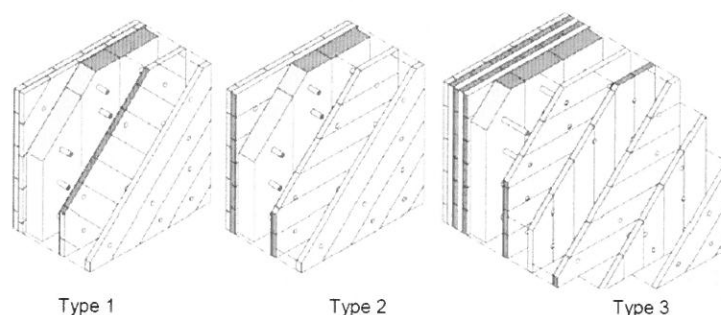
Elemento estrutural para edifícios constituído por peças de madeira ligadas por cavilhas – EAD nº 130002-00-0304
